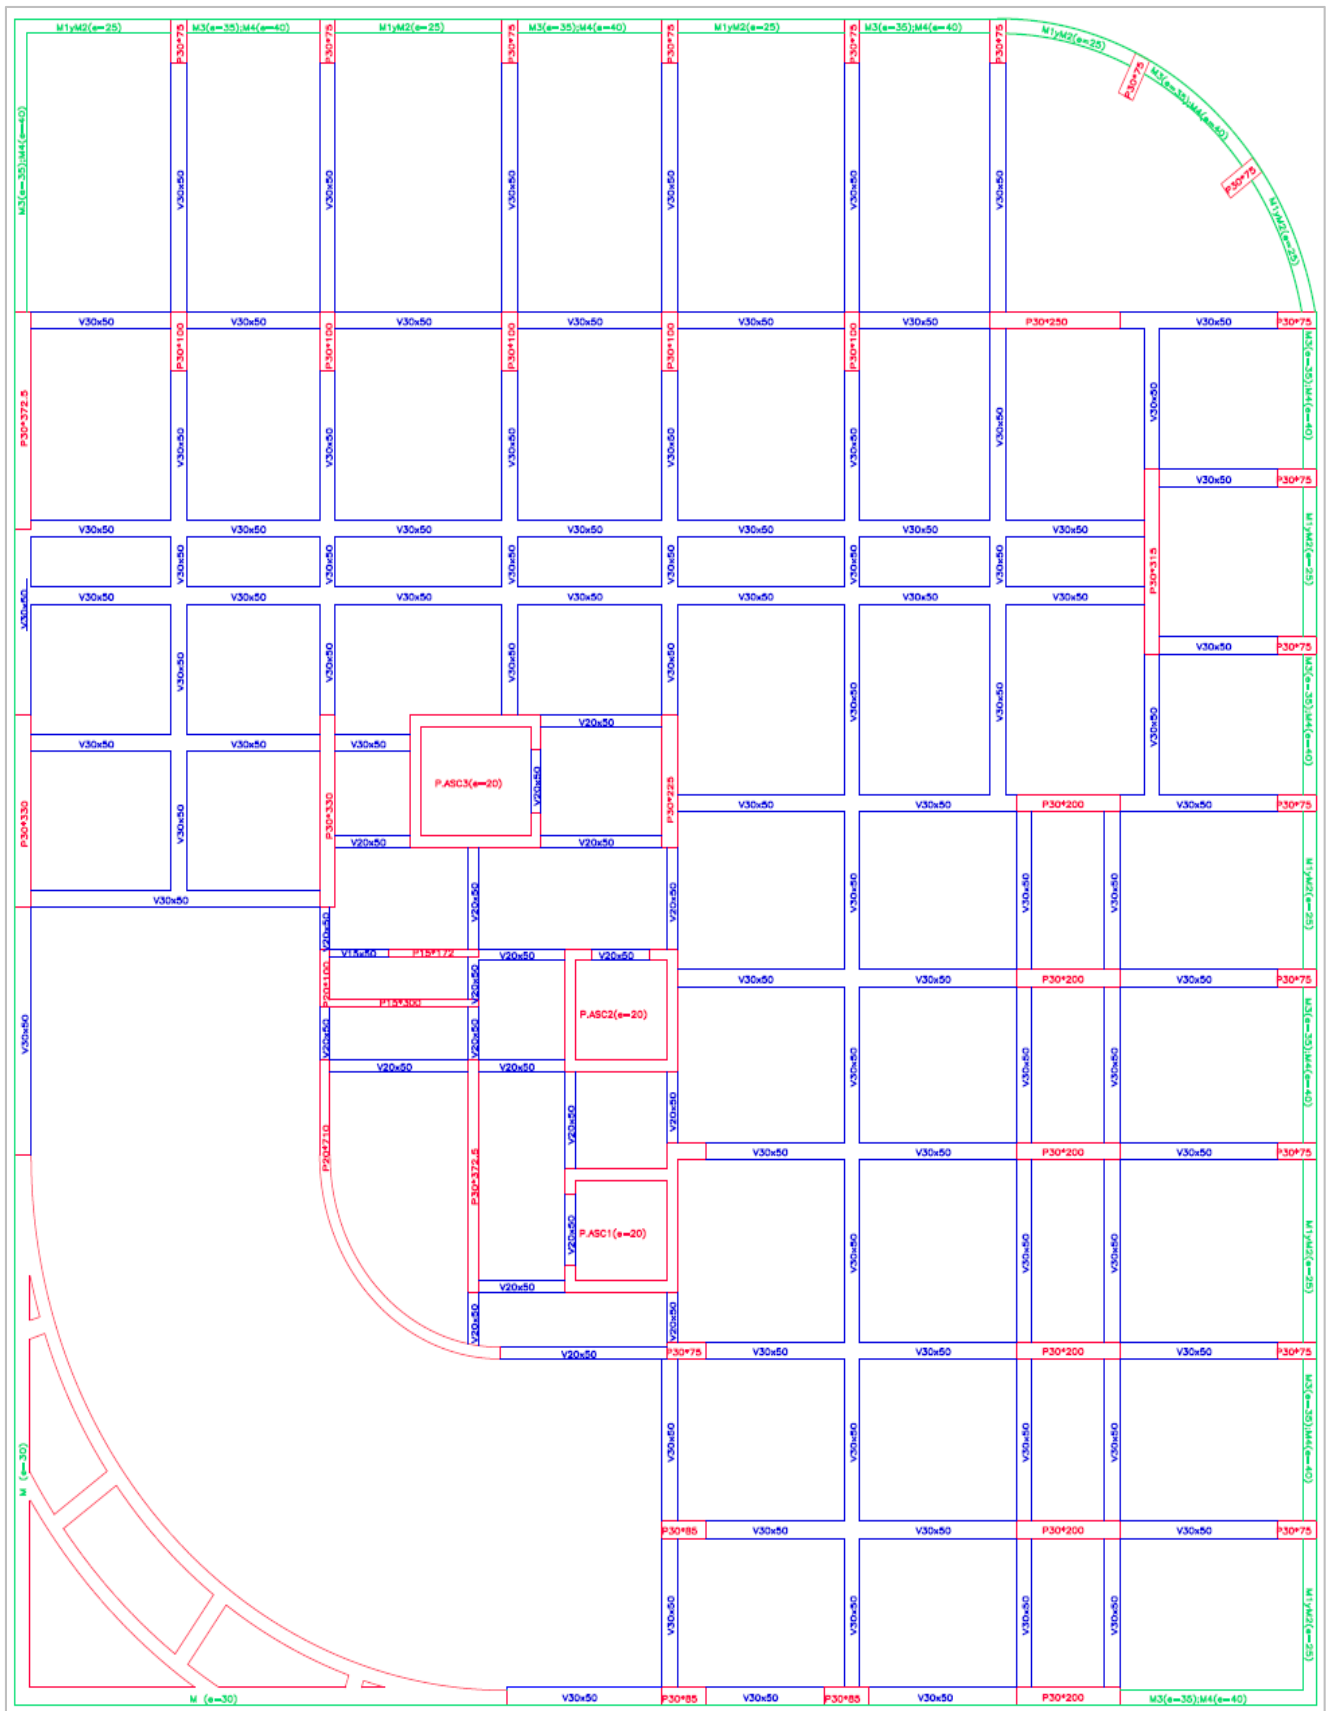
Esquema de Estructuración en Planta - Sótano 4 a Piso 1
